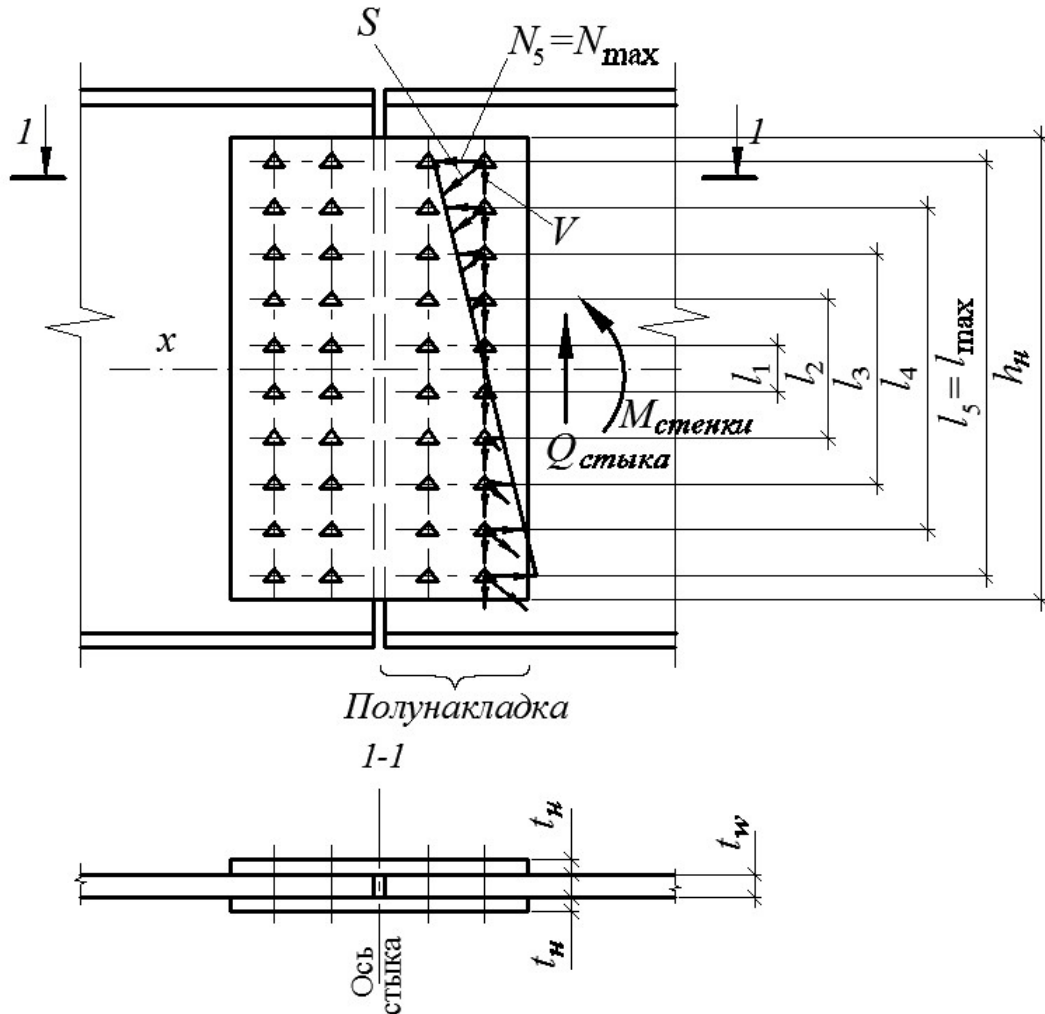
Размещение болтов в стыке стенки и схема усилий
